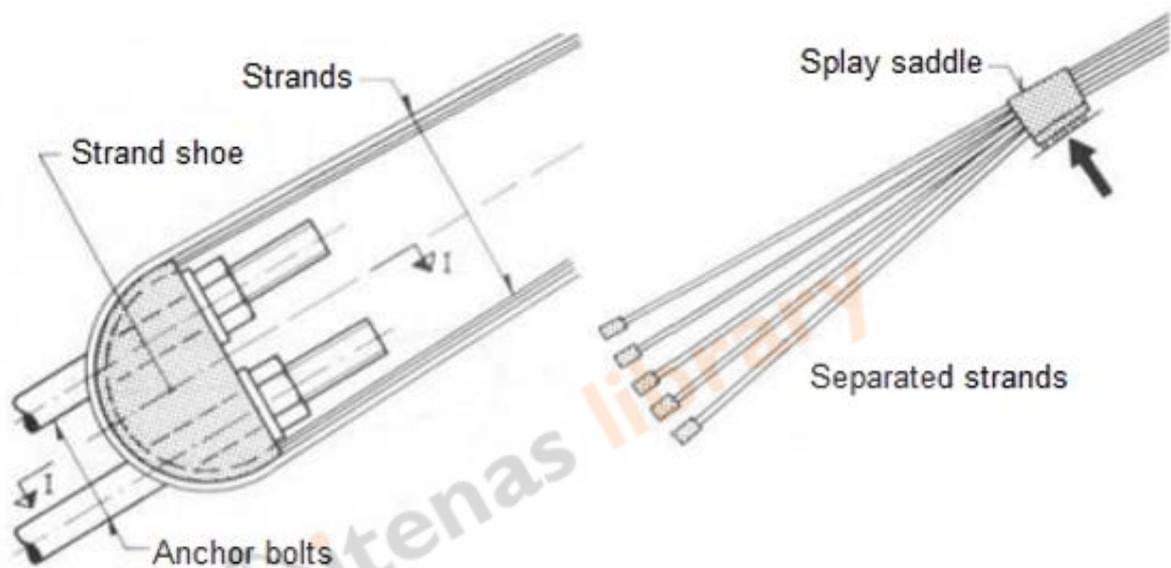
Pengankuran tunnel jembatan George Washington
